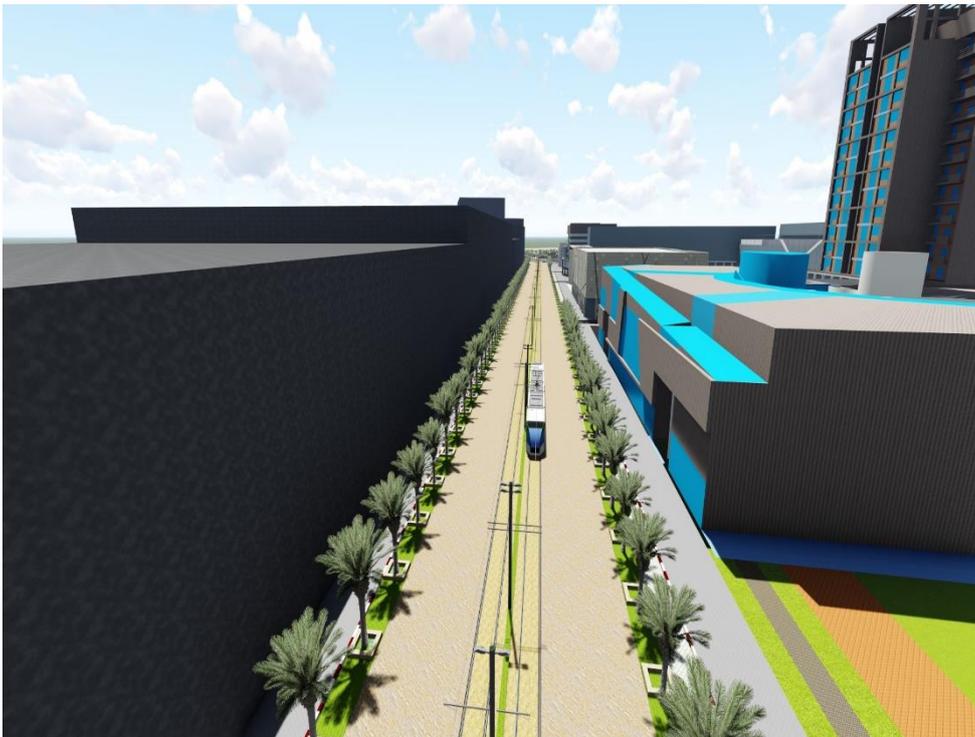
vue général sur long de paroi 8 mai après l'intervention
